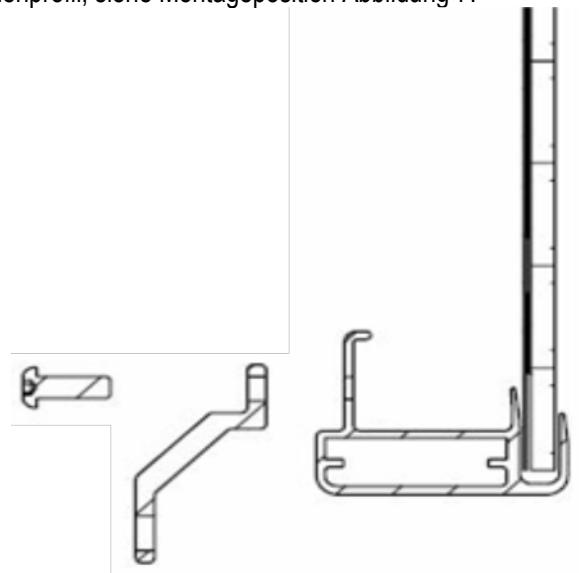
Detailansicht (Schnitt) zur Montage von zwei Wandhalterung Laschen
